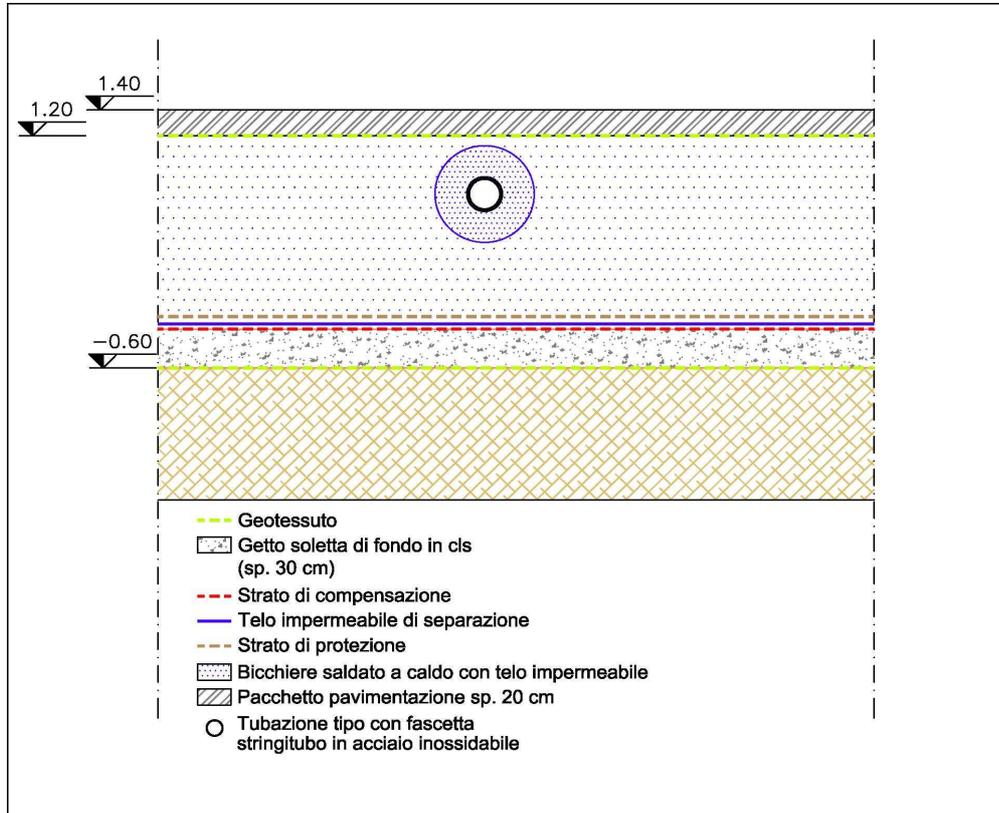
Prospetto tipo intersezione tubazione con palancole
